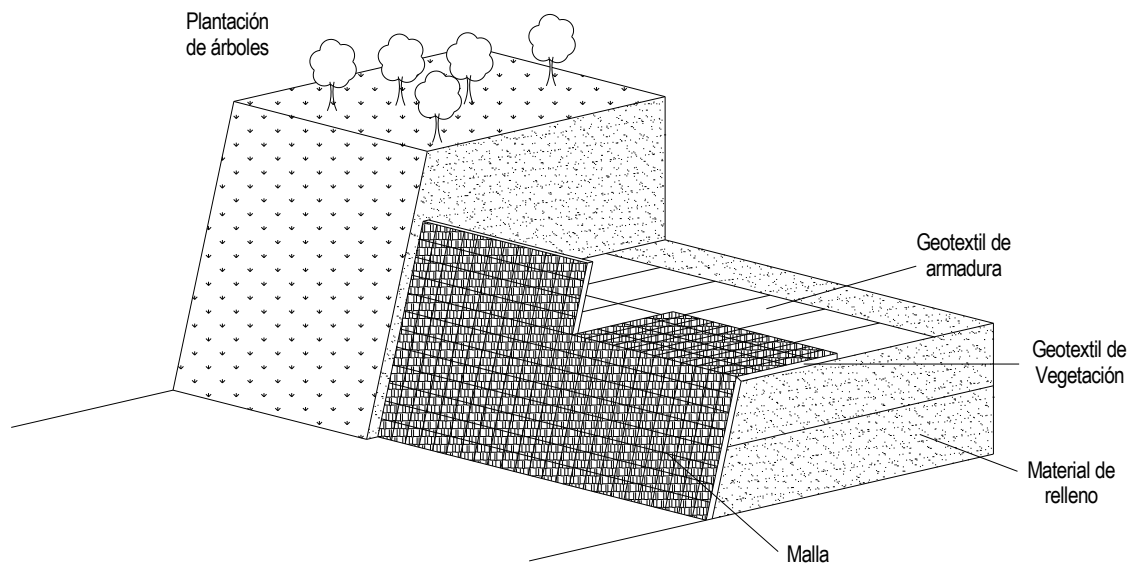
Esquema de muro en tierra armada con geotextil como refuerzo. Modificada de López et al, 1999.
